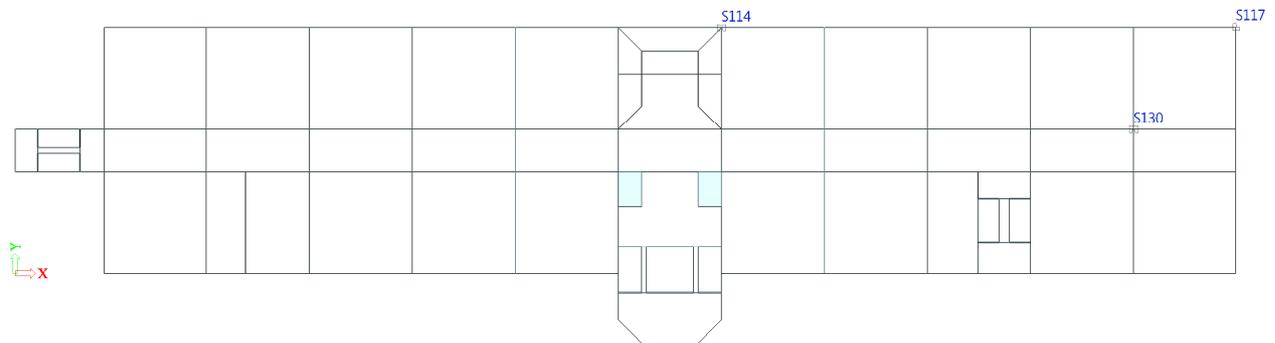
Grundriss Erdgeschoß - Position der maßgebenden Stützen
